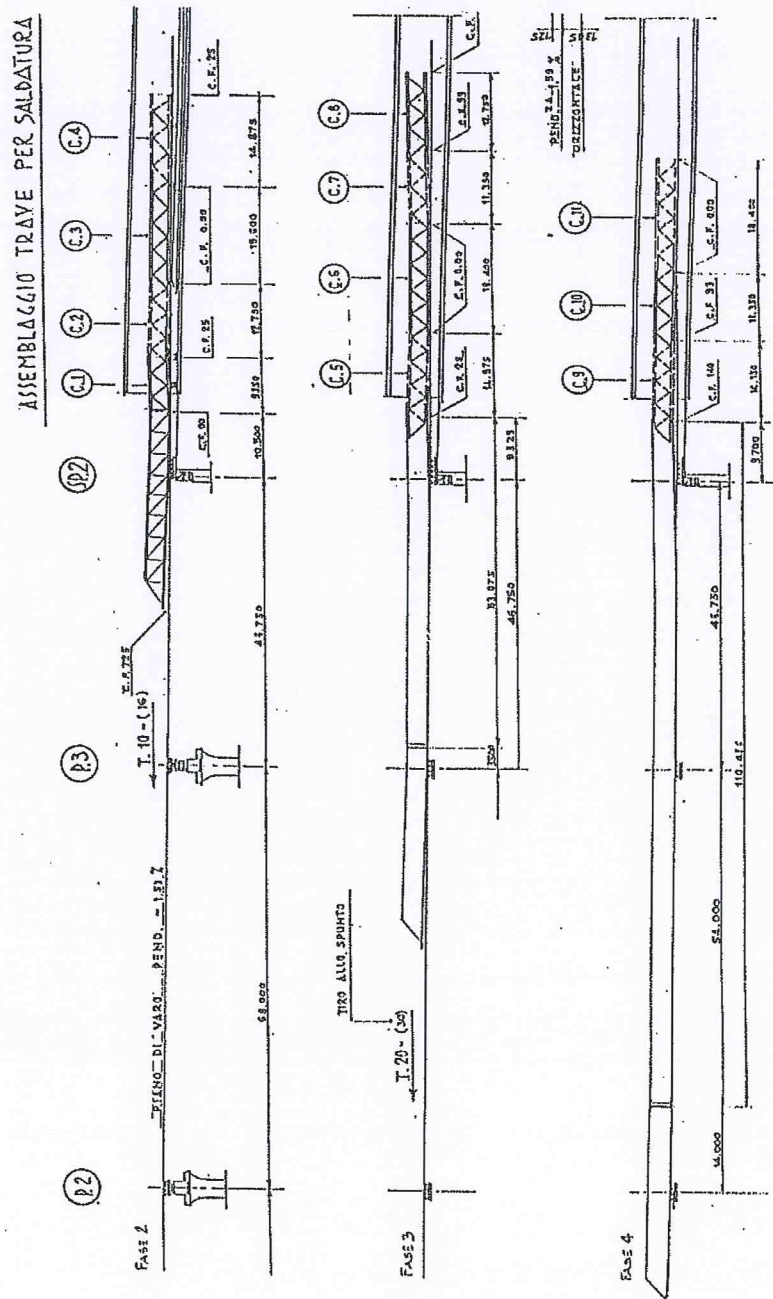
Assemblaggio trave per saldatura - Assembly stages of the beam by welding
